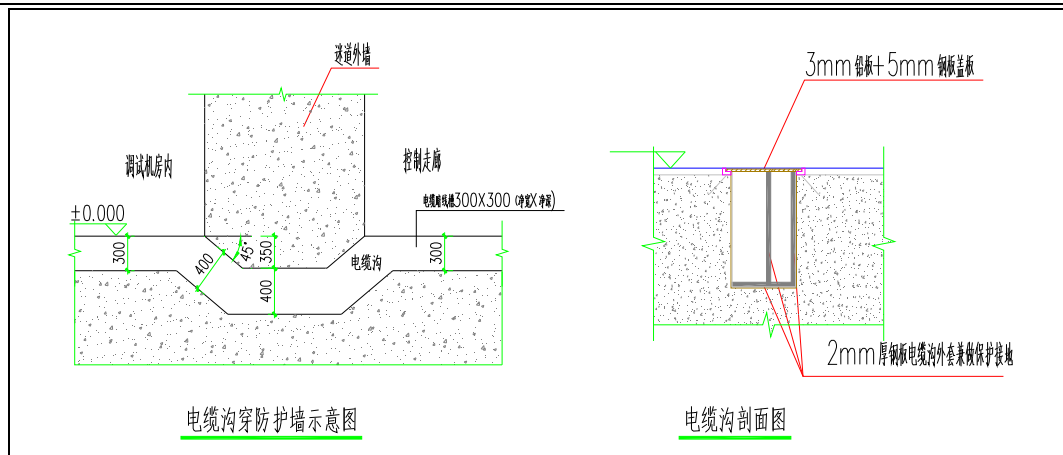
本项目加速器调试机房电缆沟剖面图及穿墙示意图（单位：mm）
